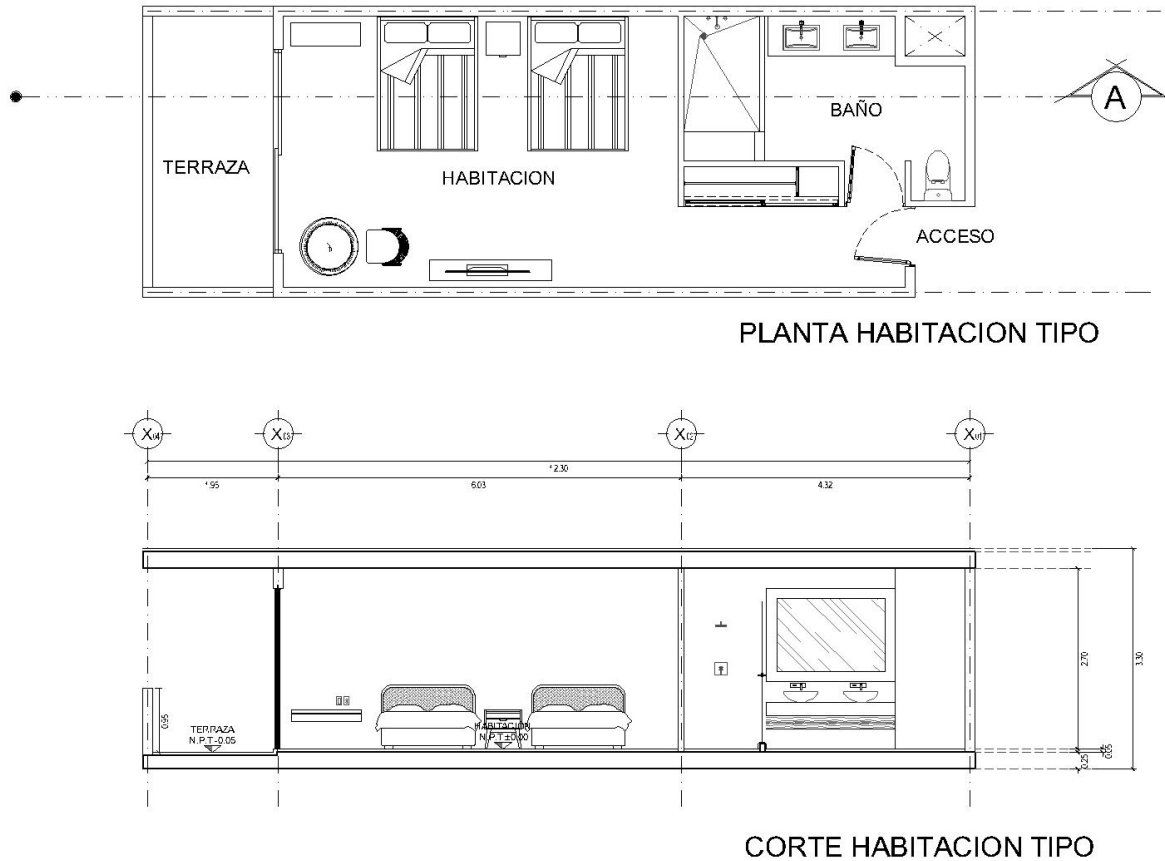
Distribución en planta y corte de la habitación tipo del hotel
